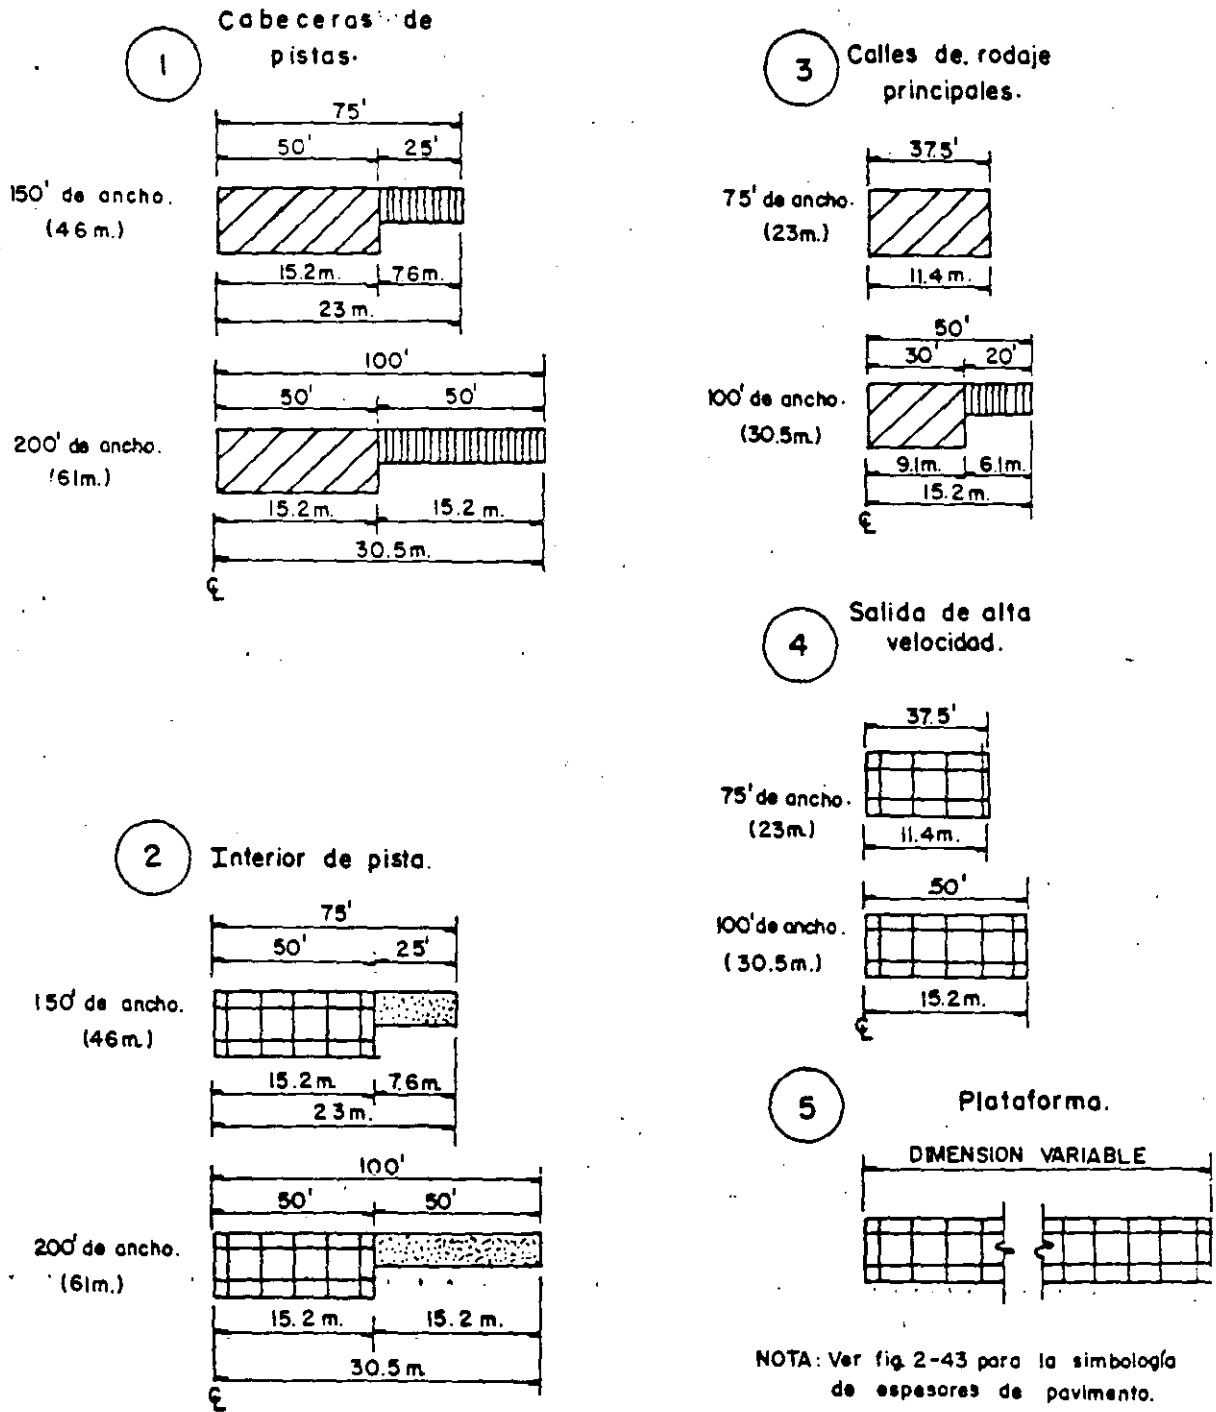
Secciones transversales de pavimento. (Instituto del asfalto 1973)
